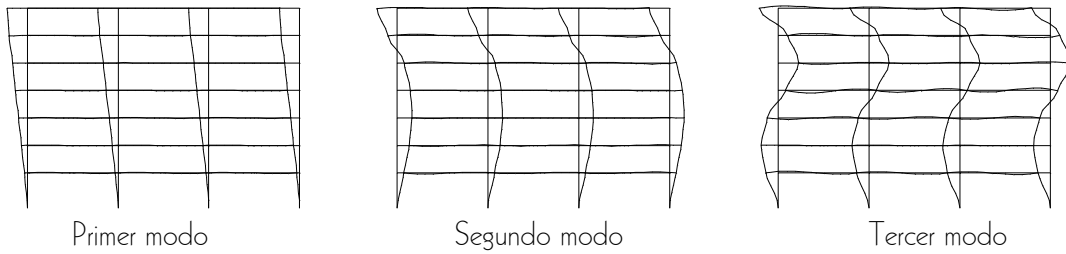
Deformadas en elevación de los primeros de vibración en las direcciones X y Y, estructuras de 7 niveles, diseño de zonas sísmicas II y III
